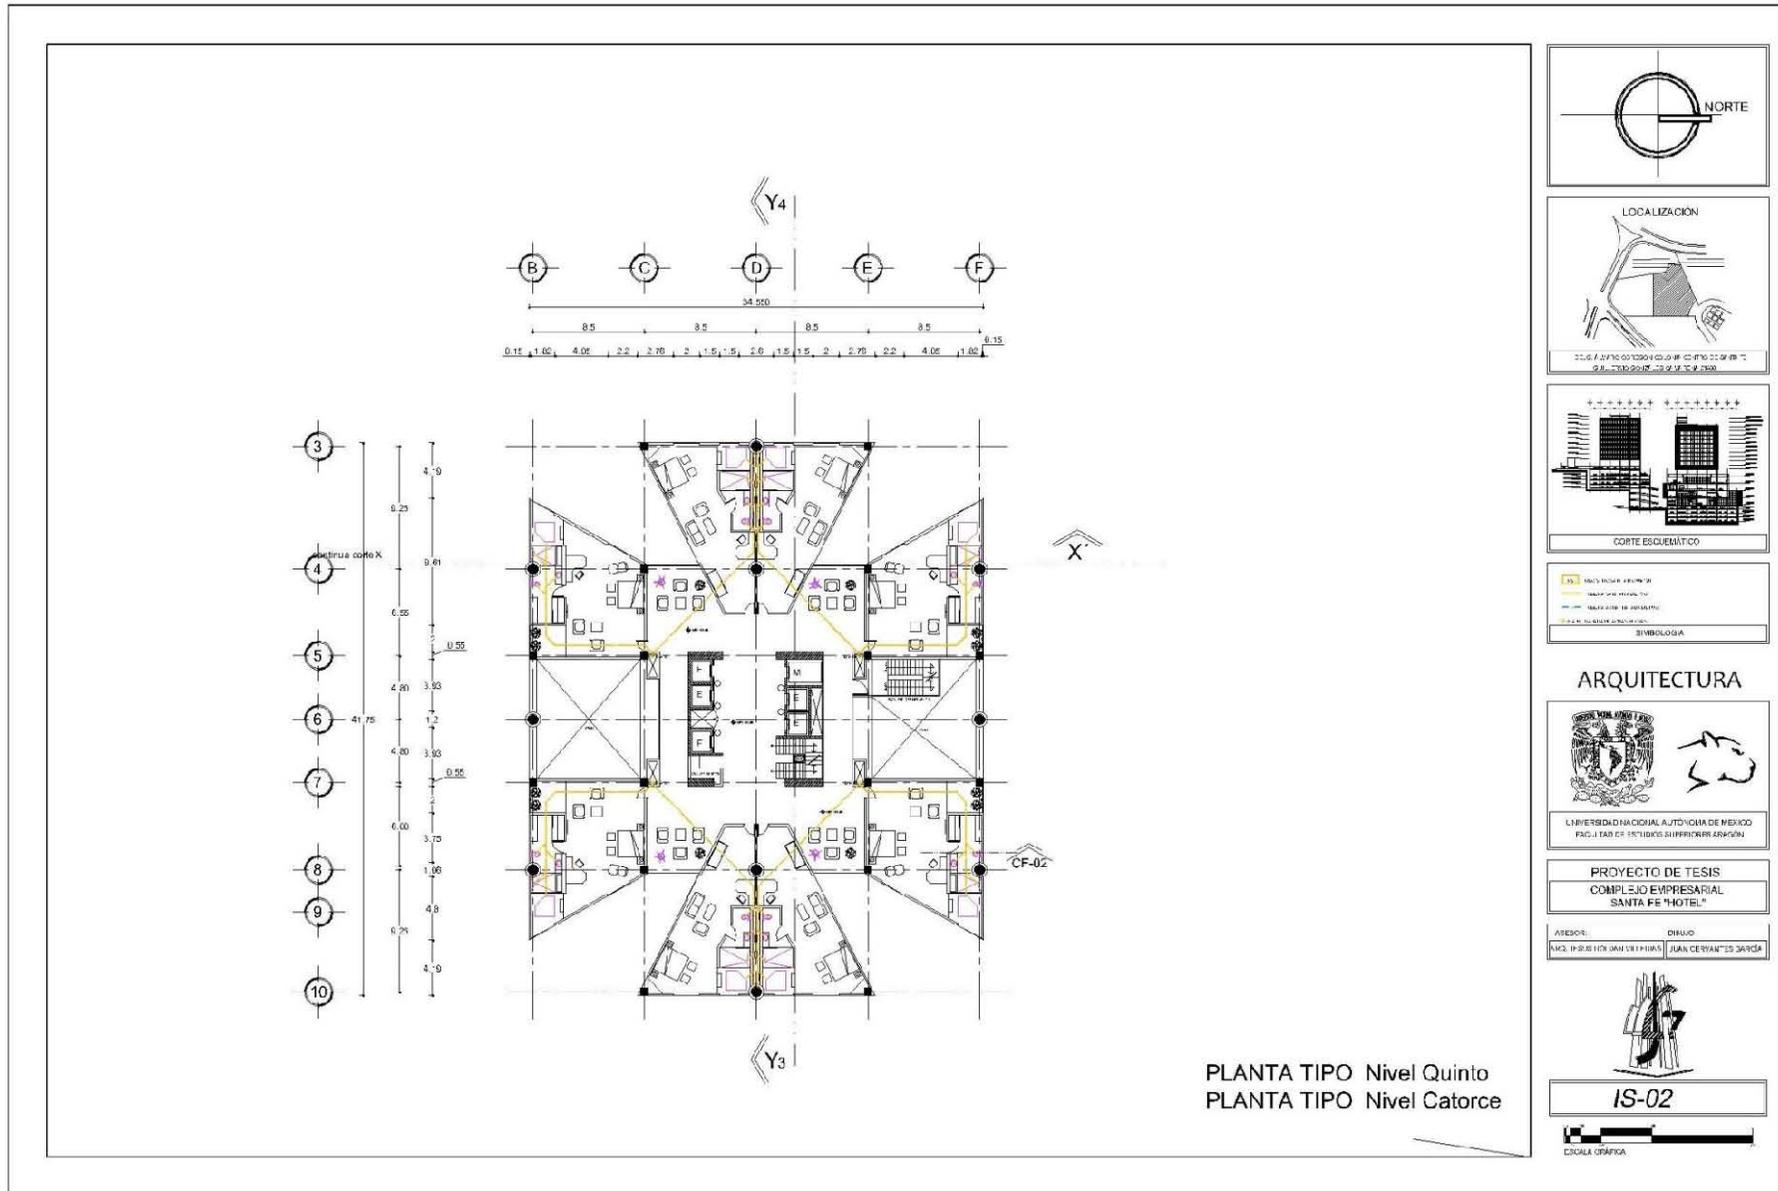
Plano IS-02; Plano instalación sanitaria en Planta Taja. Edición propia.
